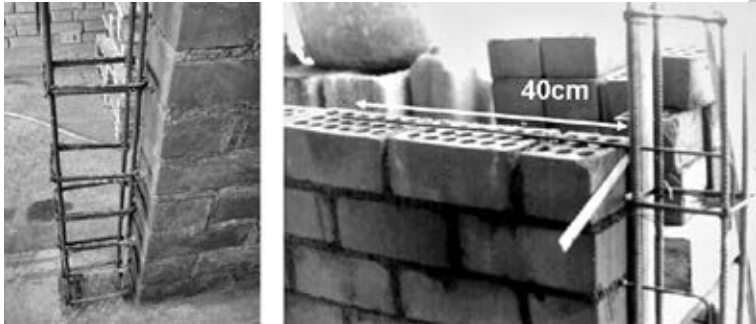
Junta a ras albañilería-columna y mechas (o chicotes) de anclaje.
